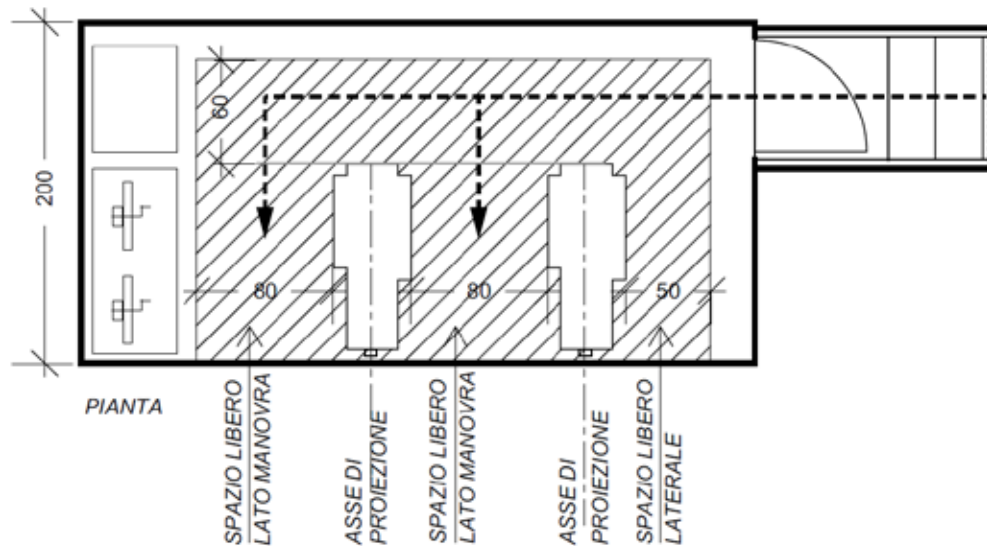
pianta di cabina di proiezione con due proiettori alternativi
